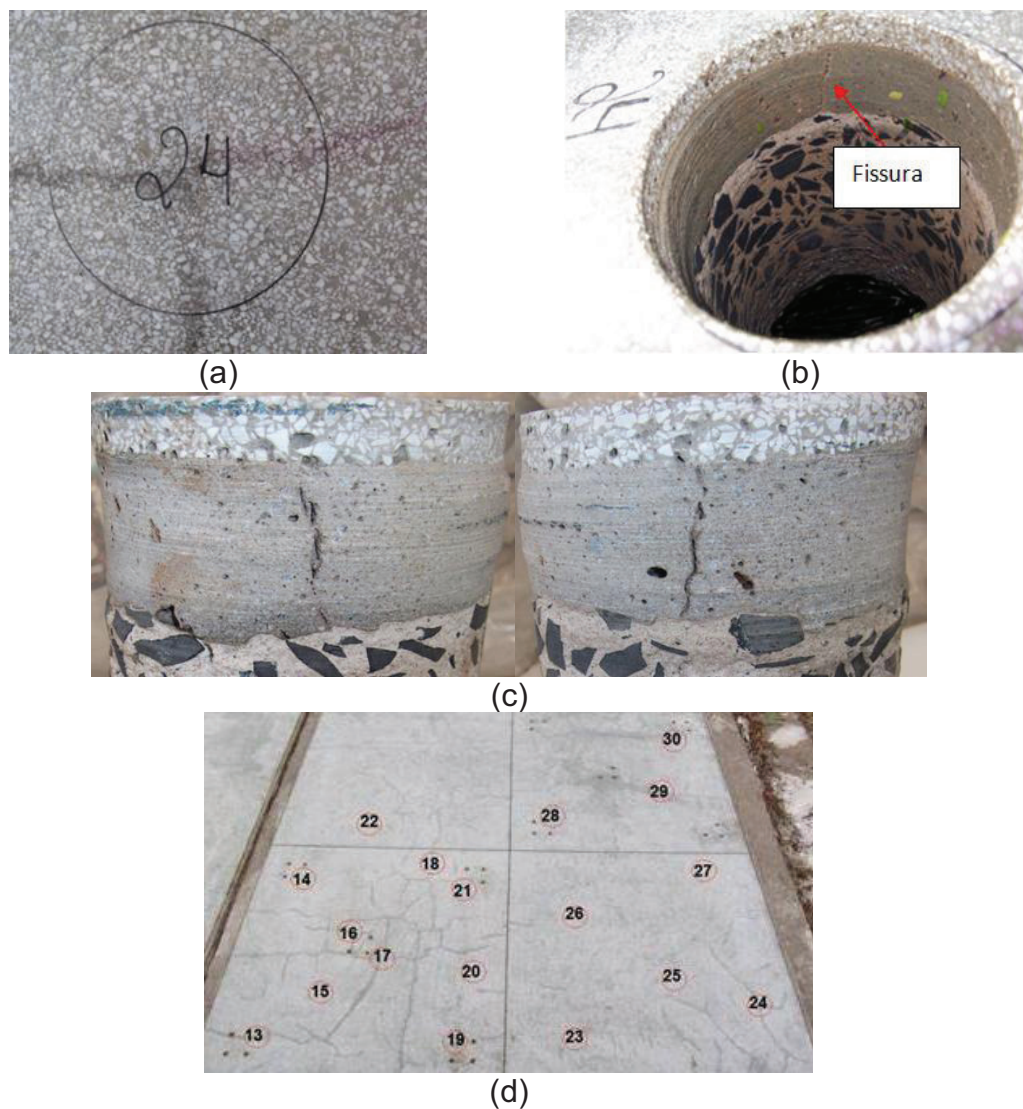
Ponto 24. (a) marcação do ponto 24; (b) fissura no ponto 24; (c) fissura no testemunho 24; (d) pontos de extração de testemunhos do Quadro III.
